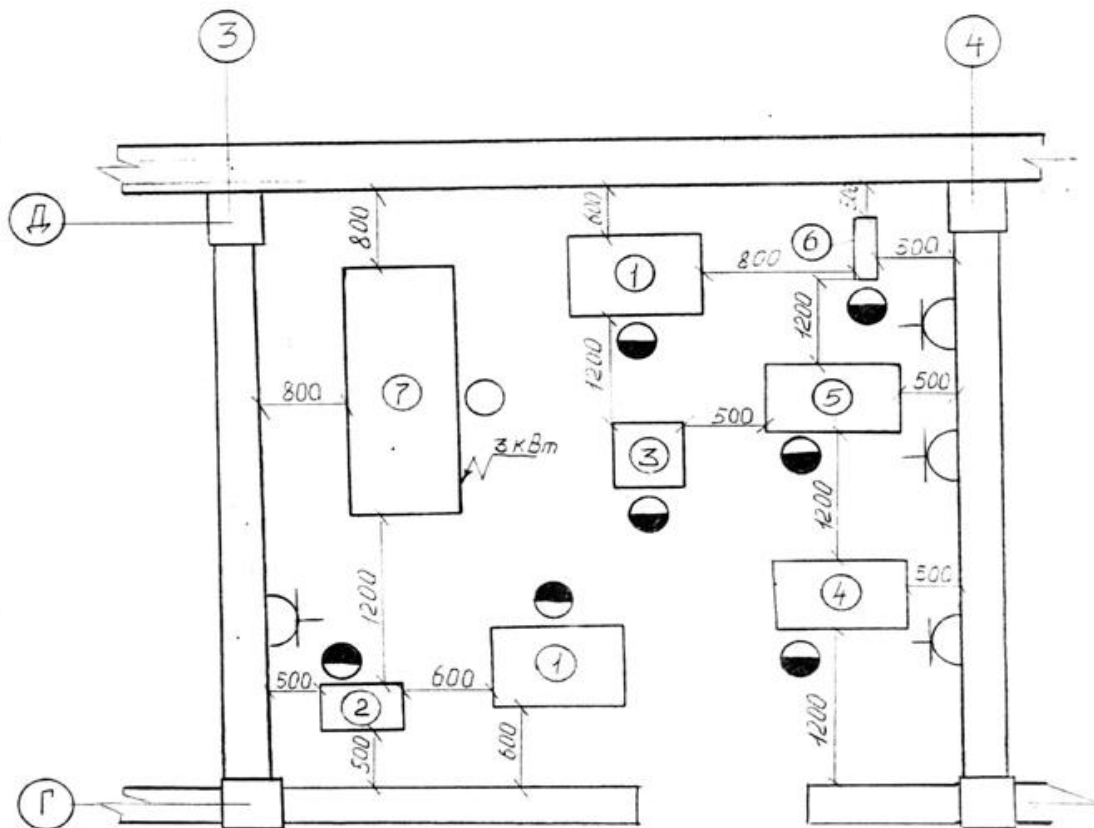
Планировка агрегатно-механического участка: 1 – верстак слесарный 070-03; 2 – тумбочка для станочного инструмента 0125Н-9935; 3 – стенд для разборки и сборки задних мостов Р-292; 4 – стенд для ремонта двигателей Р-297; 5 – стенд для разборки, сборки сцепления Р-297; 6 – пресс гидравлический 2153-М2; 7 – станок токарно-винторезный 16К20.
